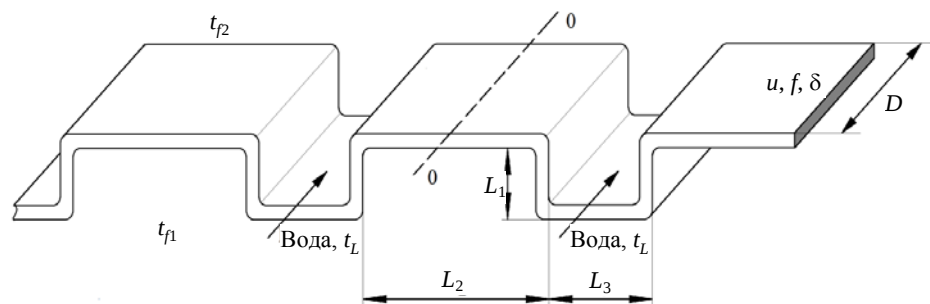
Принципиальная схема конструкции металлочерепицы кровли животноводческого помещения
